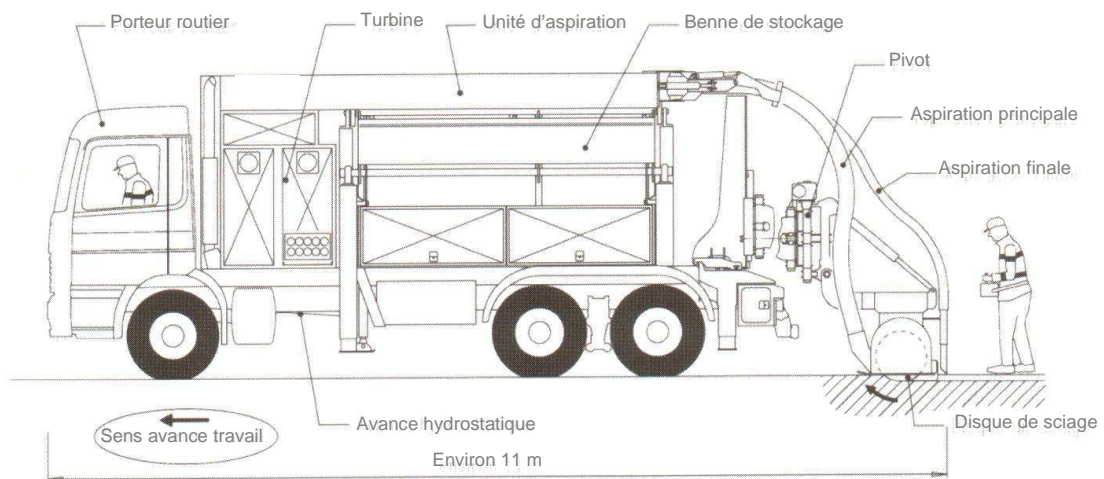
schéma technique et vue de la machine de micro-tranchage pour voies express, roclades, autoroutes
